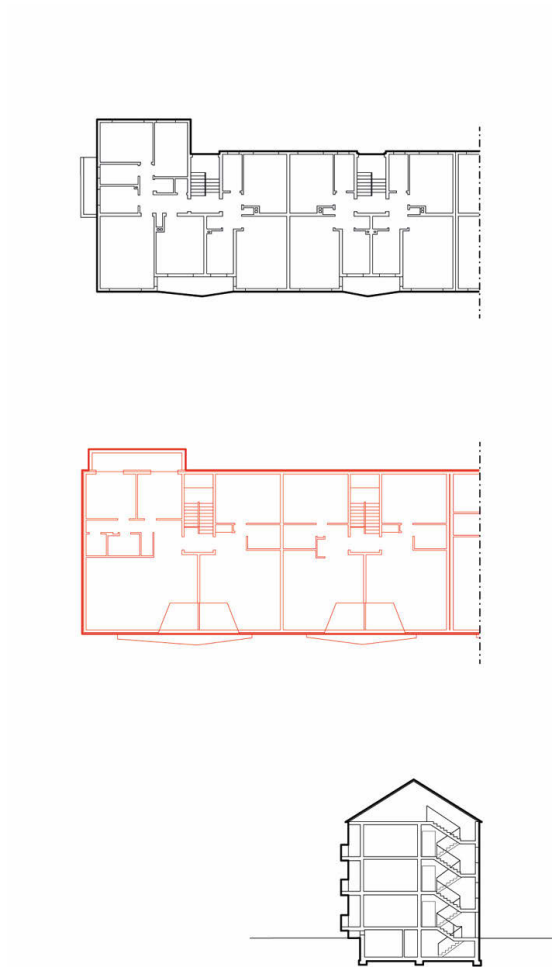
Grundrisse & Schnitte Bestand – Aufstockung 1, Piccoloministraße
